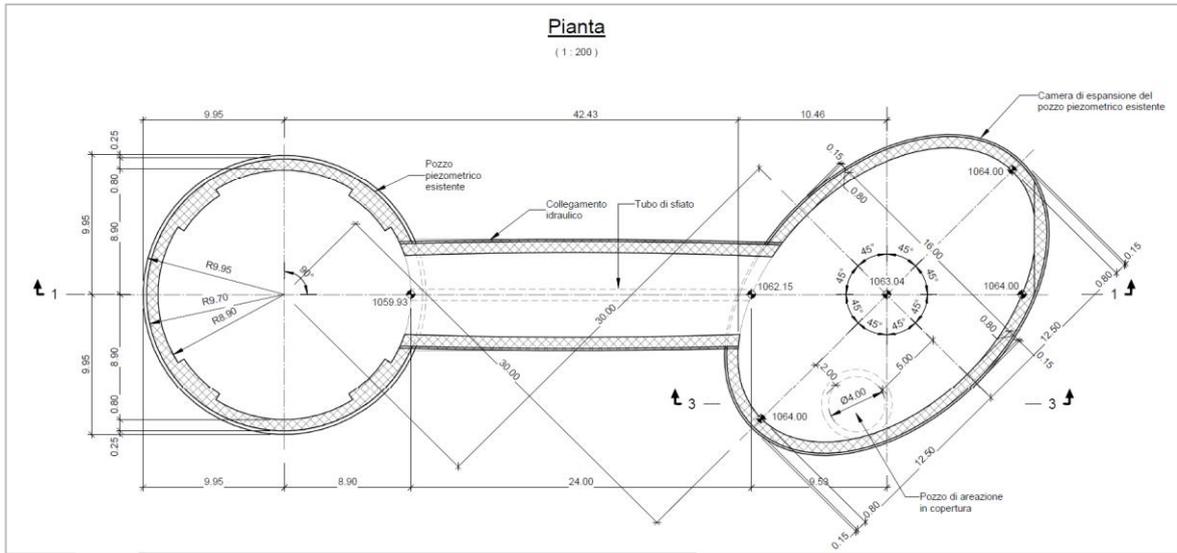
Nuova camera di espansione al pozzo piezometrico sulla derivazione Provvidenza – pianta
